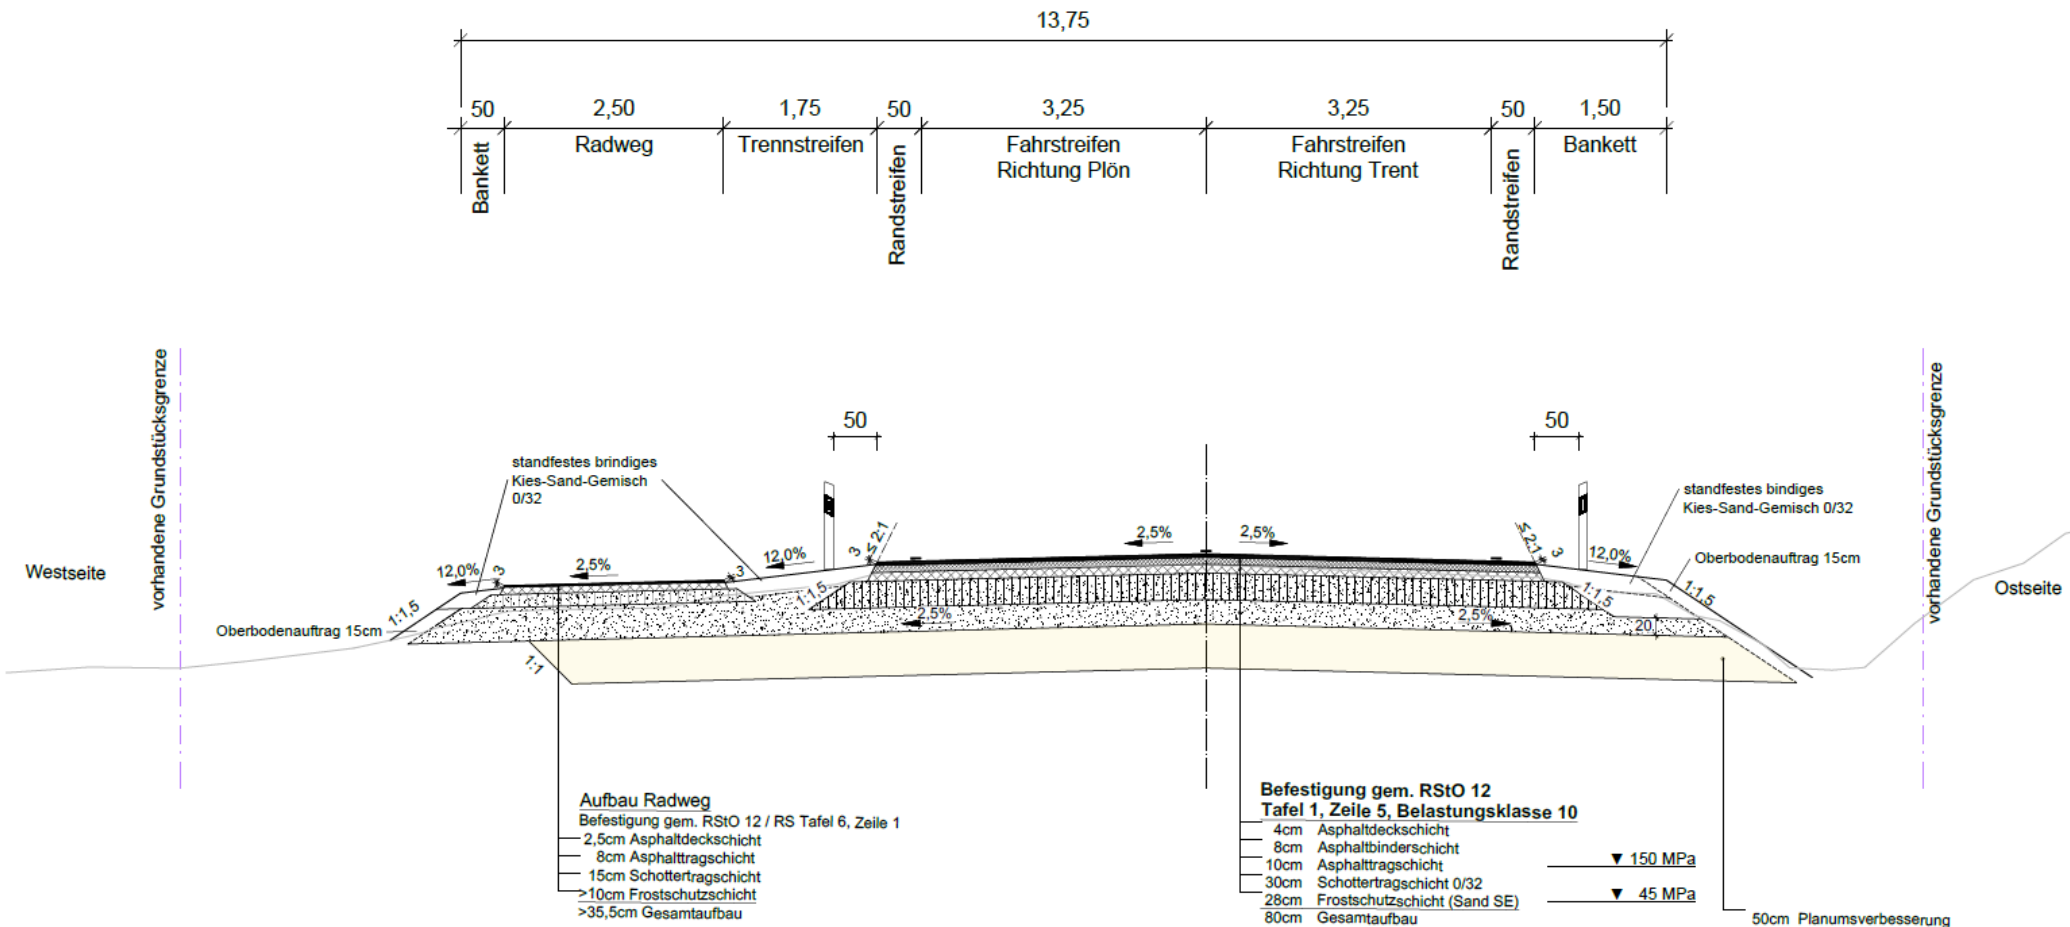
Querschnitt Grundhafte Erneuerung mit Planumsverbesserung
